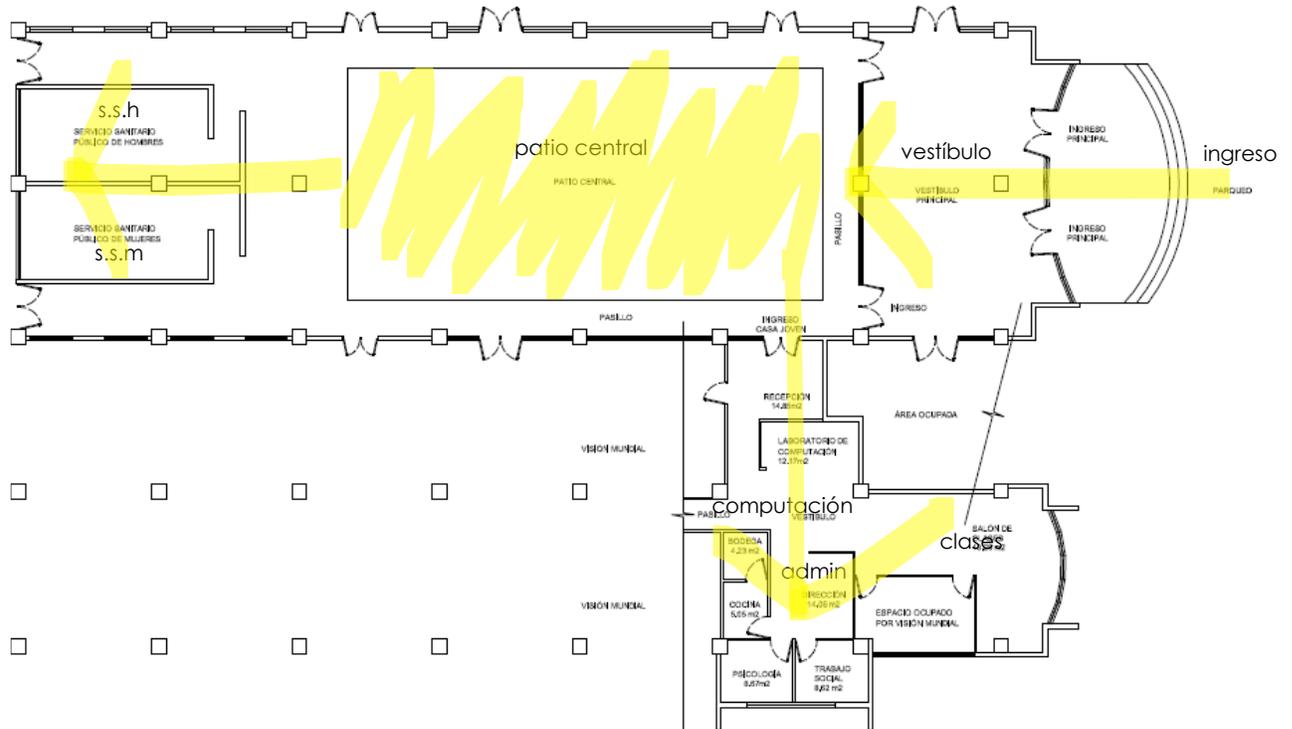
Planta de Conjunto Casa Joven Palencia.
